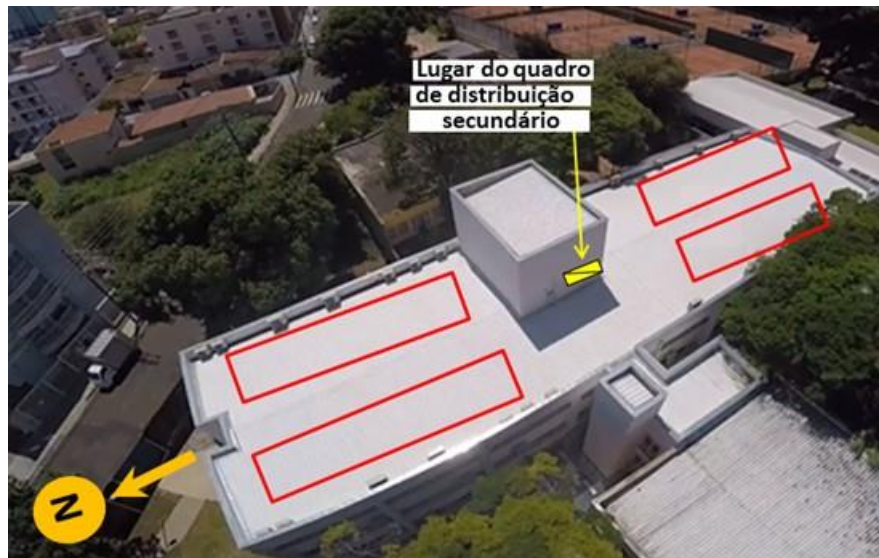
(ICMC-3Pes) Vista de cima do lugar da instalação com distâncias e layout dos módulos.
